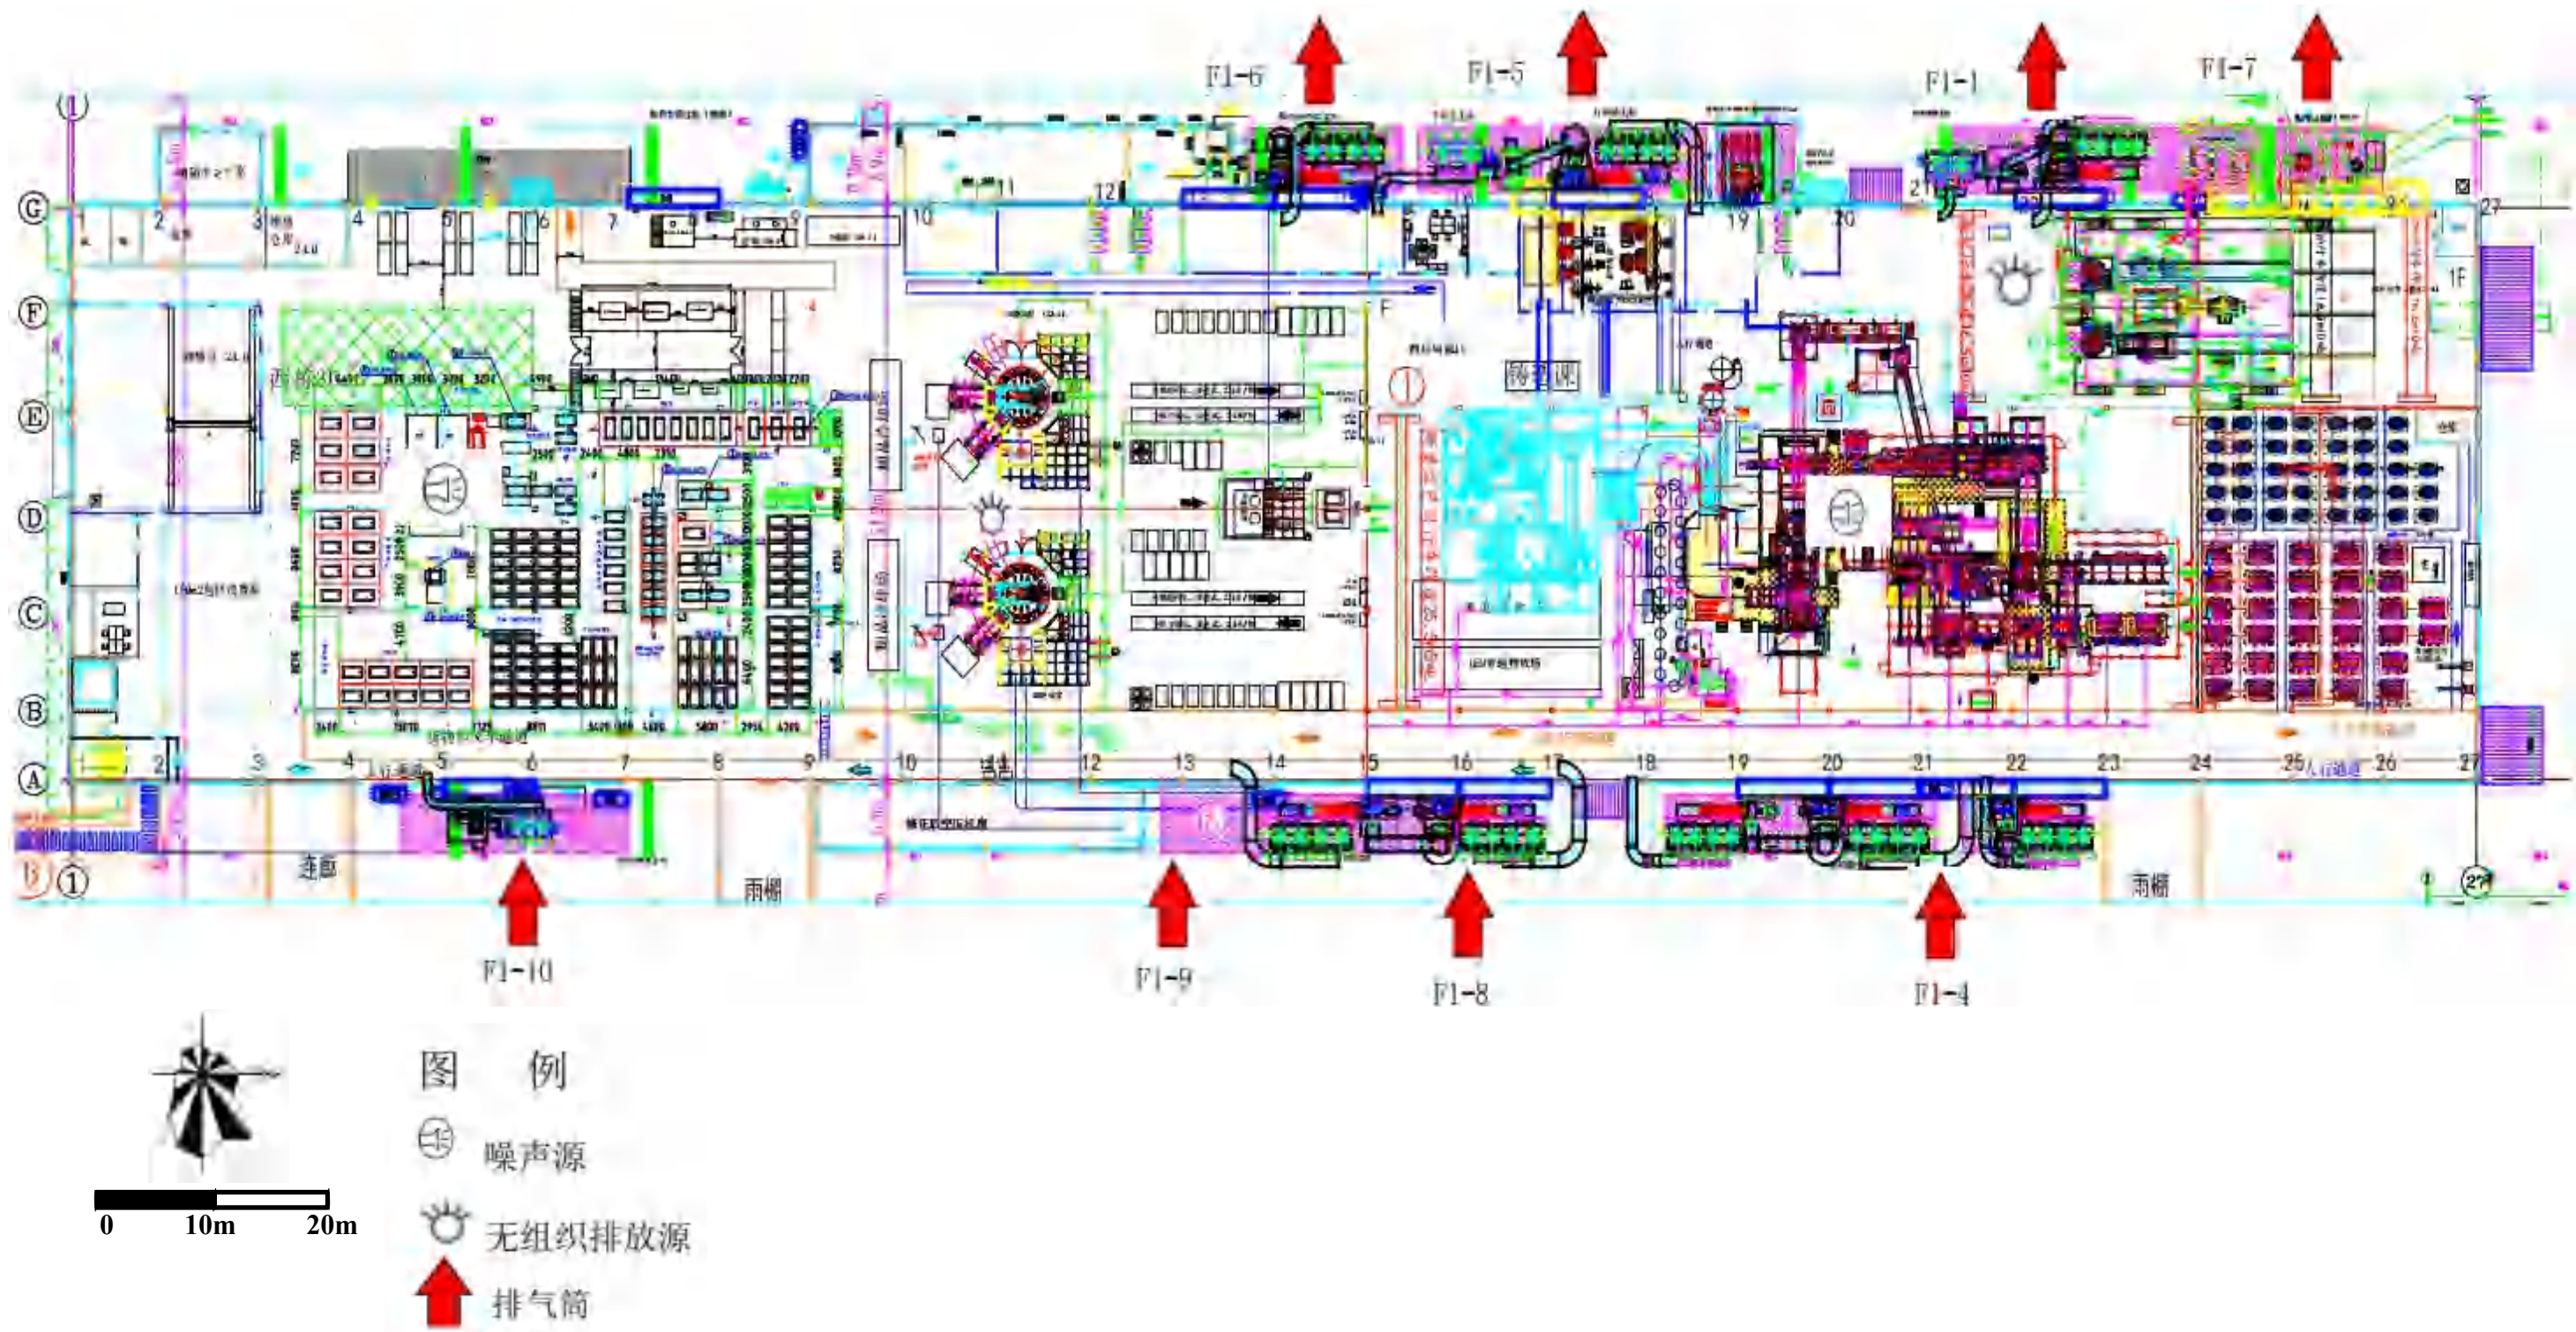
(1) 搪瓷浴缸西栋 1F 平面布置图
